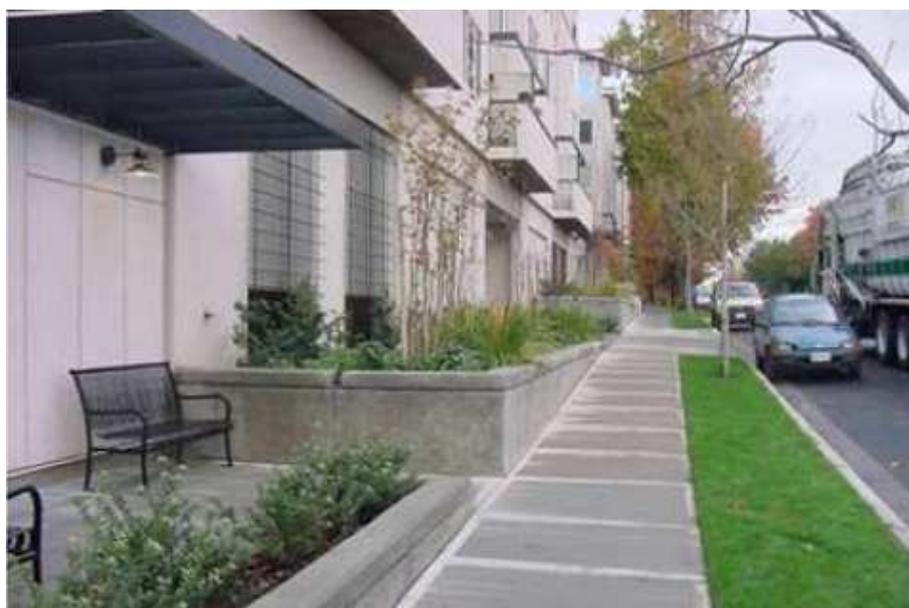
Plano de infiltração constituído por uma faixa de grama na Calçada.
